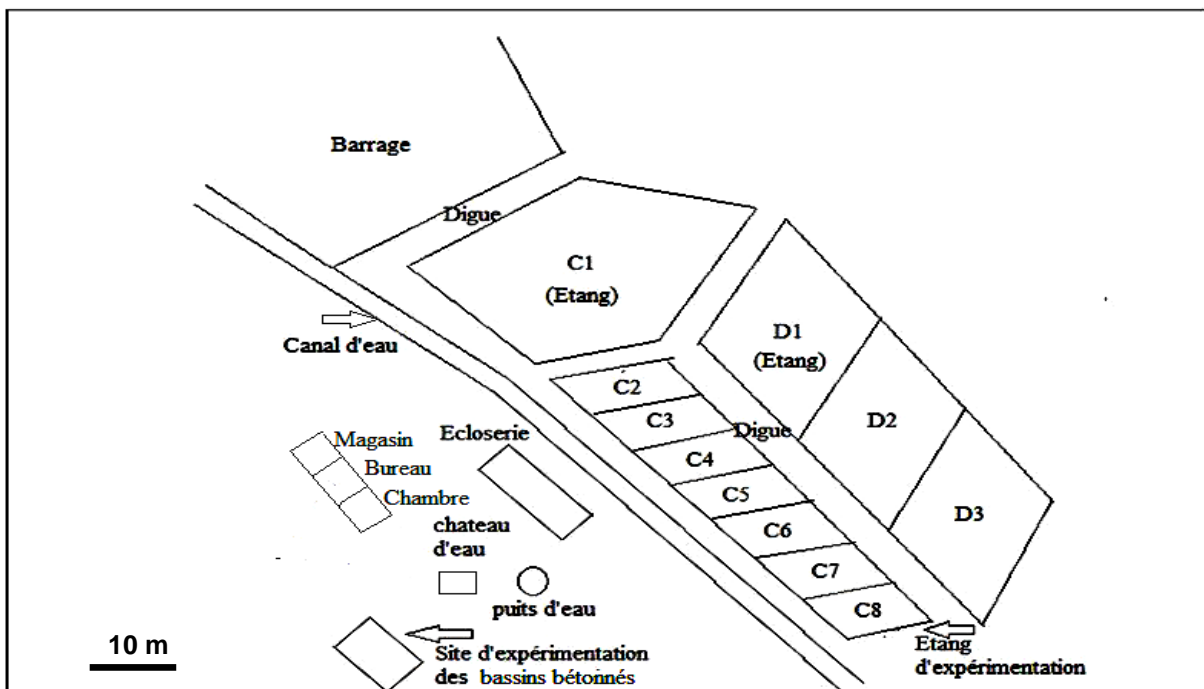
Plan de masse des infrastructures d'élevage de la ferme piscicole de l'APDRACI (Source : APDRACI)
